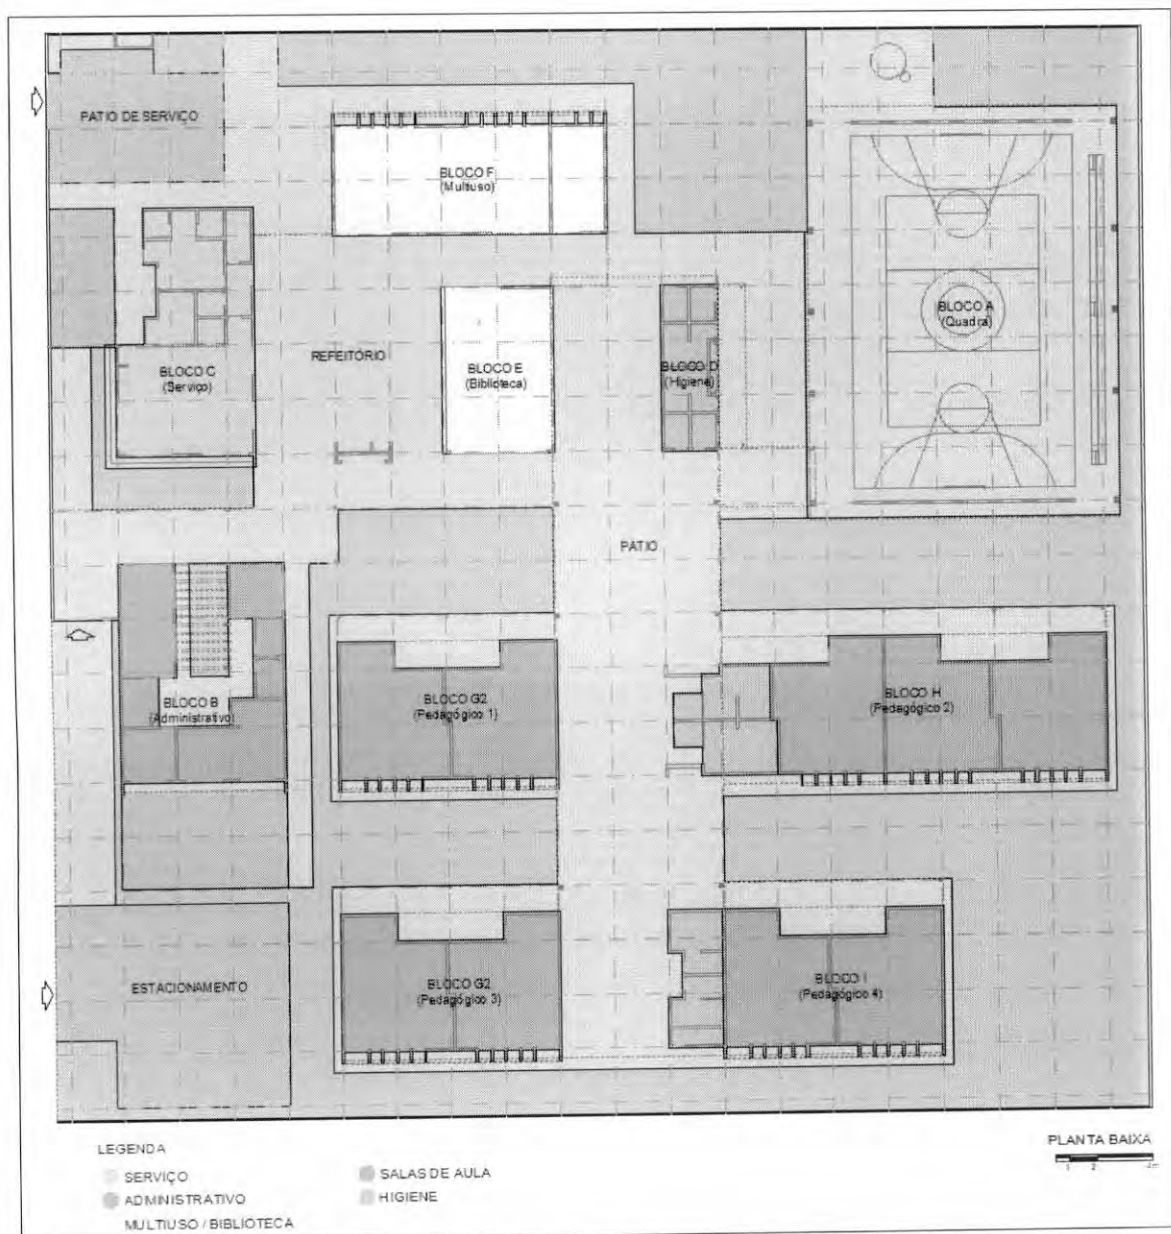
planta baixa de implantação dos blocos – Escola 9 Salas - Térreo
